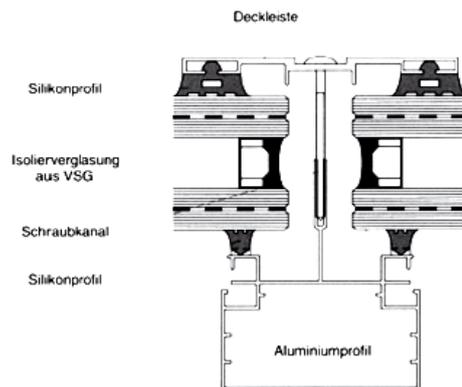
Lagerung einer Isolierglasscheibe und Soghalterung nach [ 3 ]
